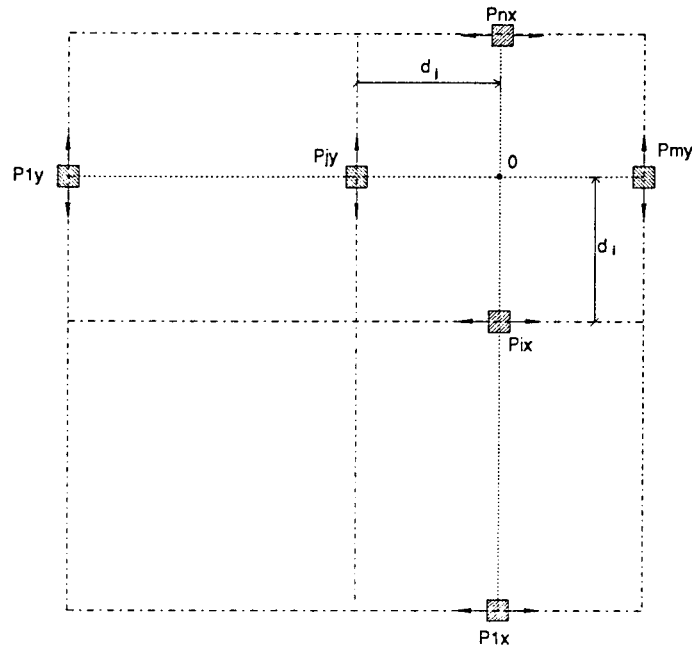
Estrutura equivalente - Planta esquemática.
